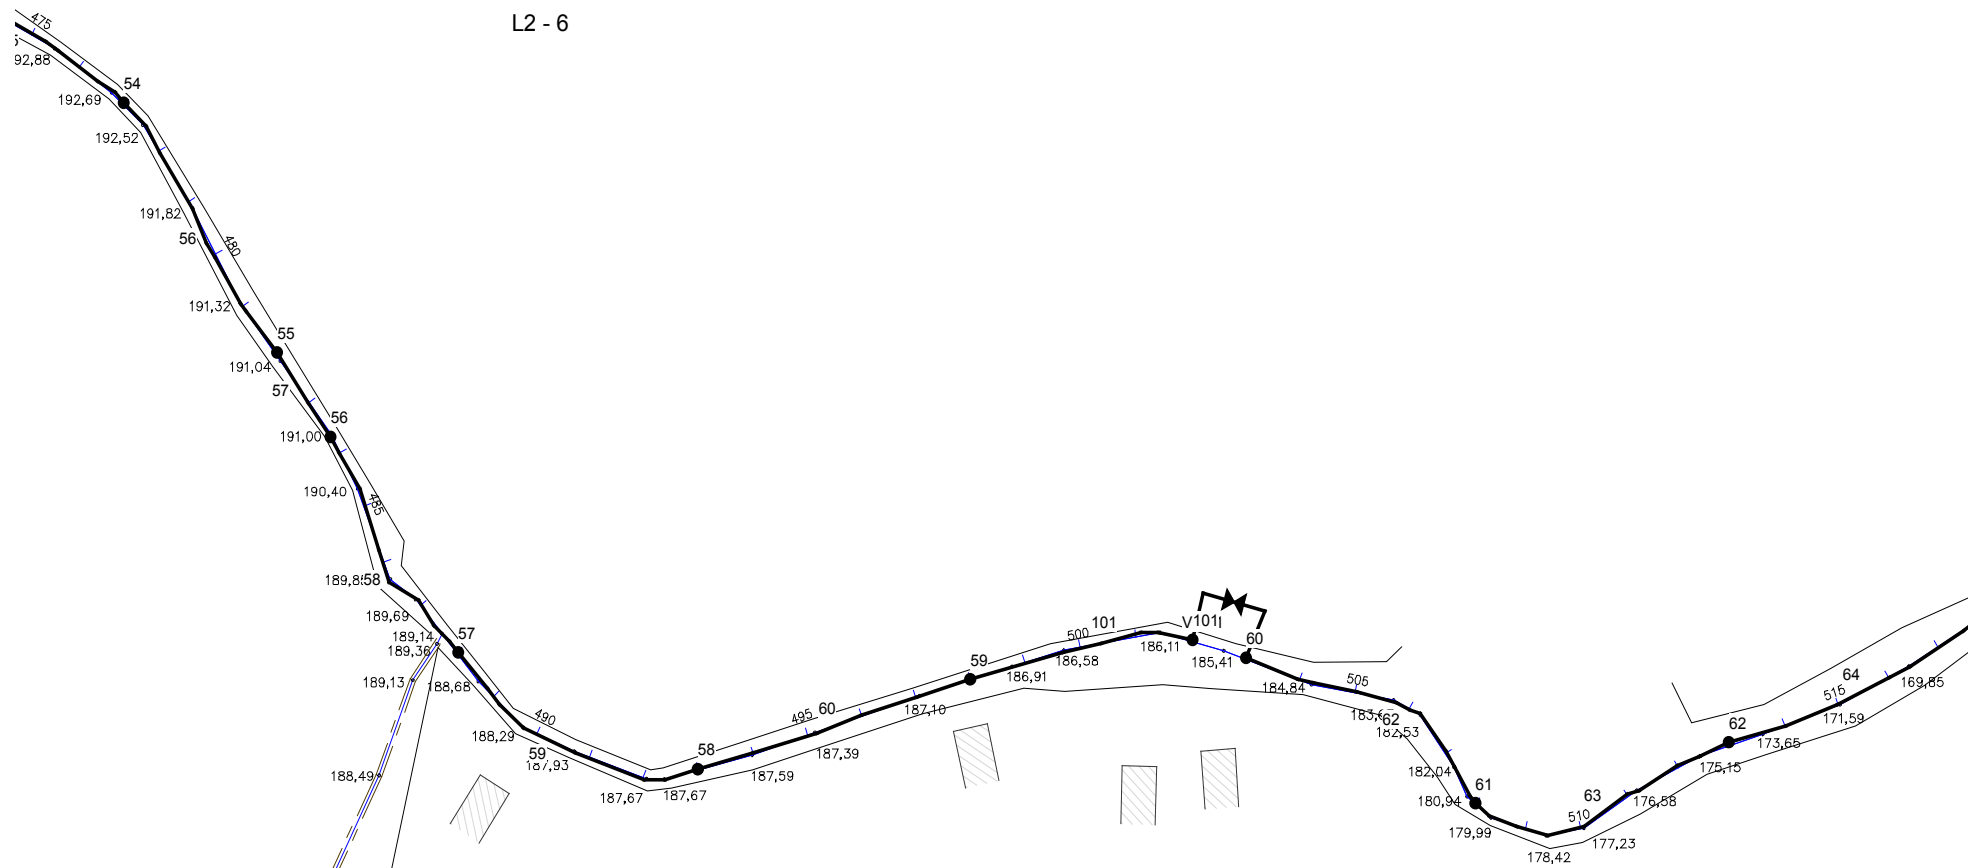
EPANET parcial 6 – Rede de Lajes 2
